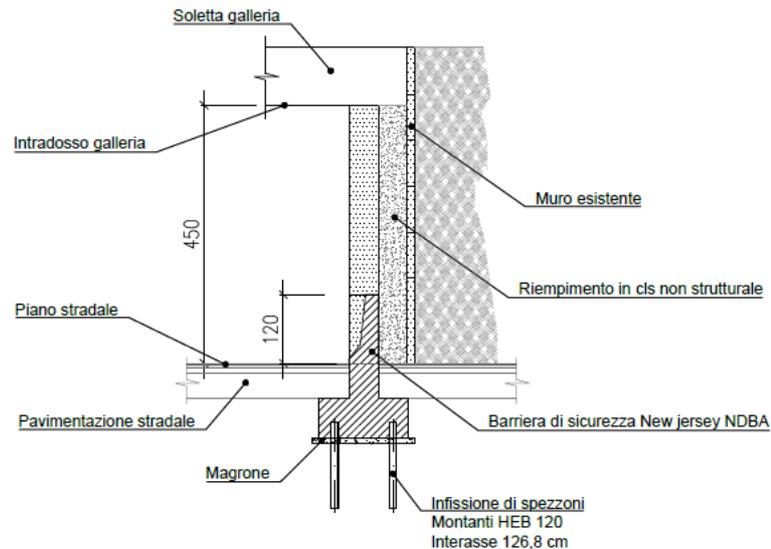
Opera a protezione dell'imbocco della galleria – sezione trasversale
